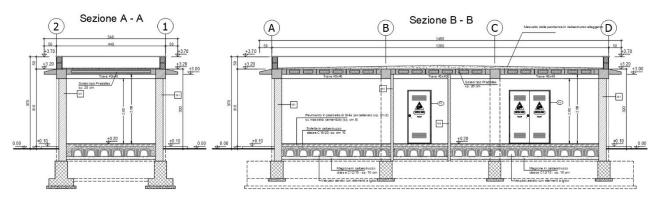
Edificio ENEL - Sezione A-A e B-B
